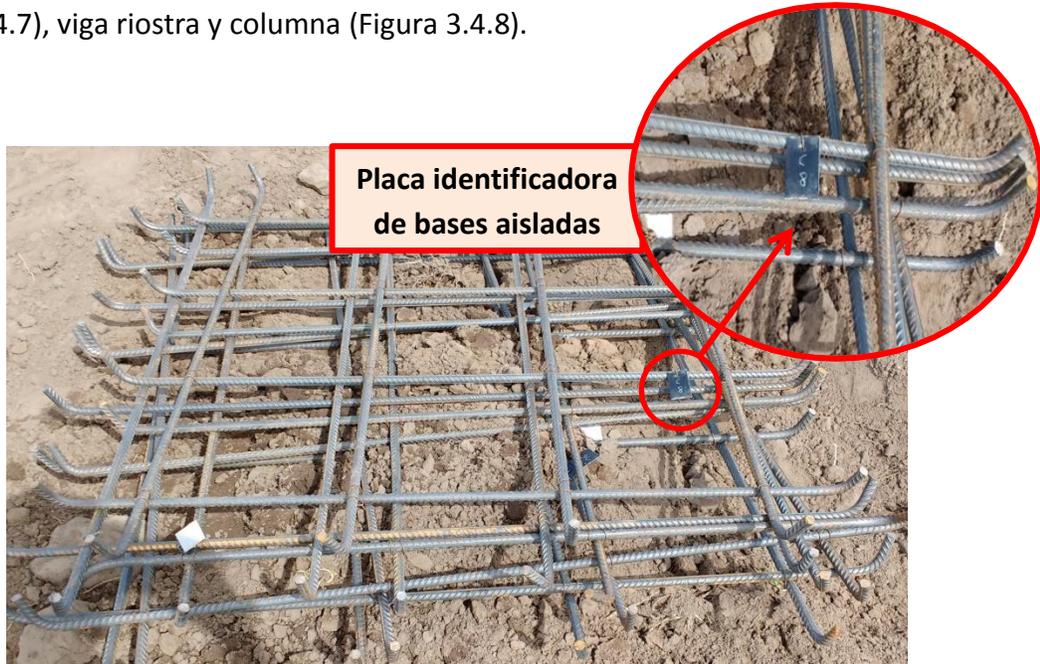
Placa identificadora de armadura de bases aisladas
